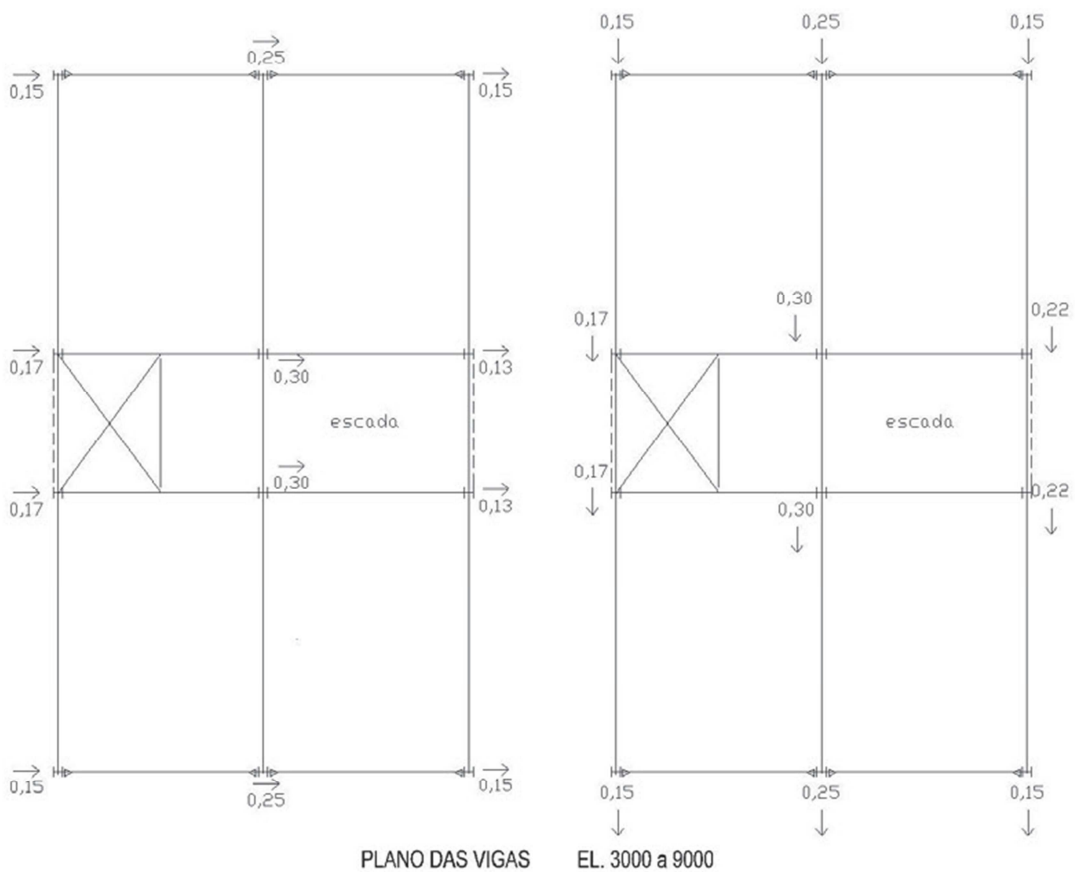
19 – Aplicação das Forças Nocionais no Plano do Pavimento Tipo
